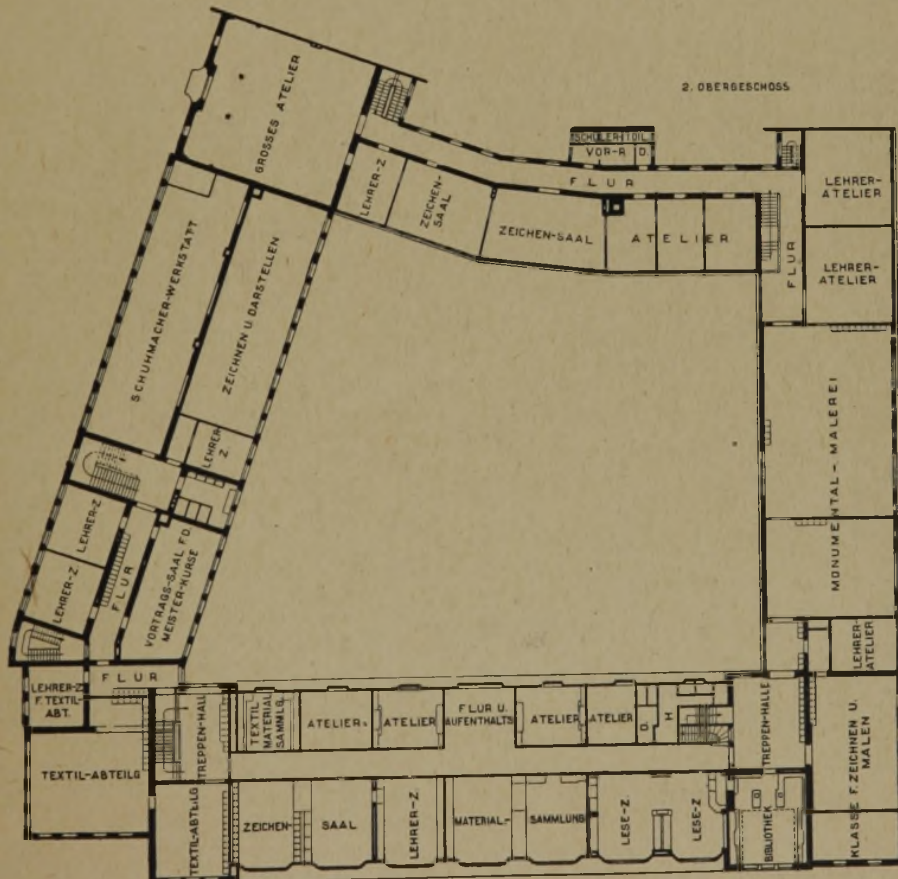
Grundriß des II. Obergeschosses (1:600).
